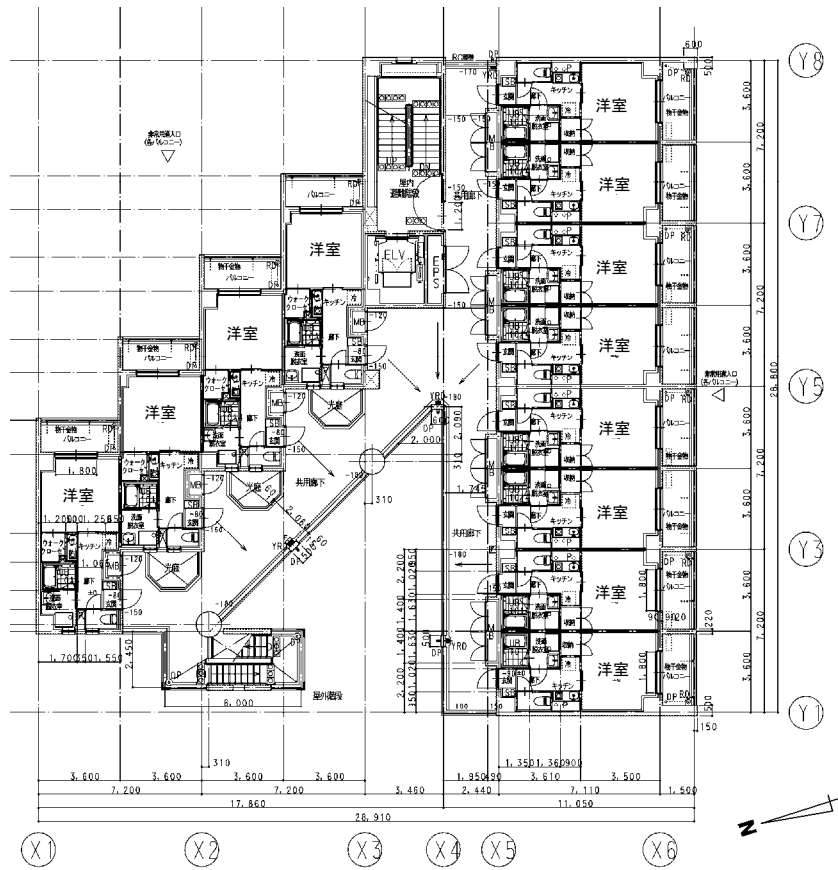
研修医宿舎棟建築平面図 (4・5階)
